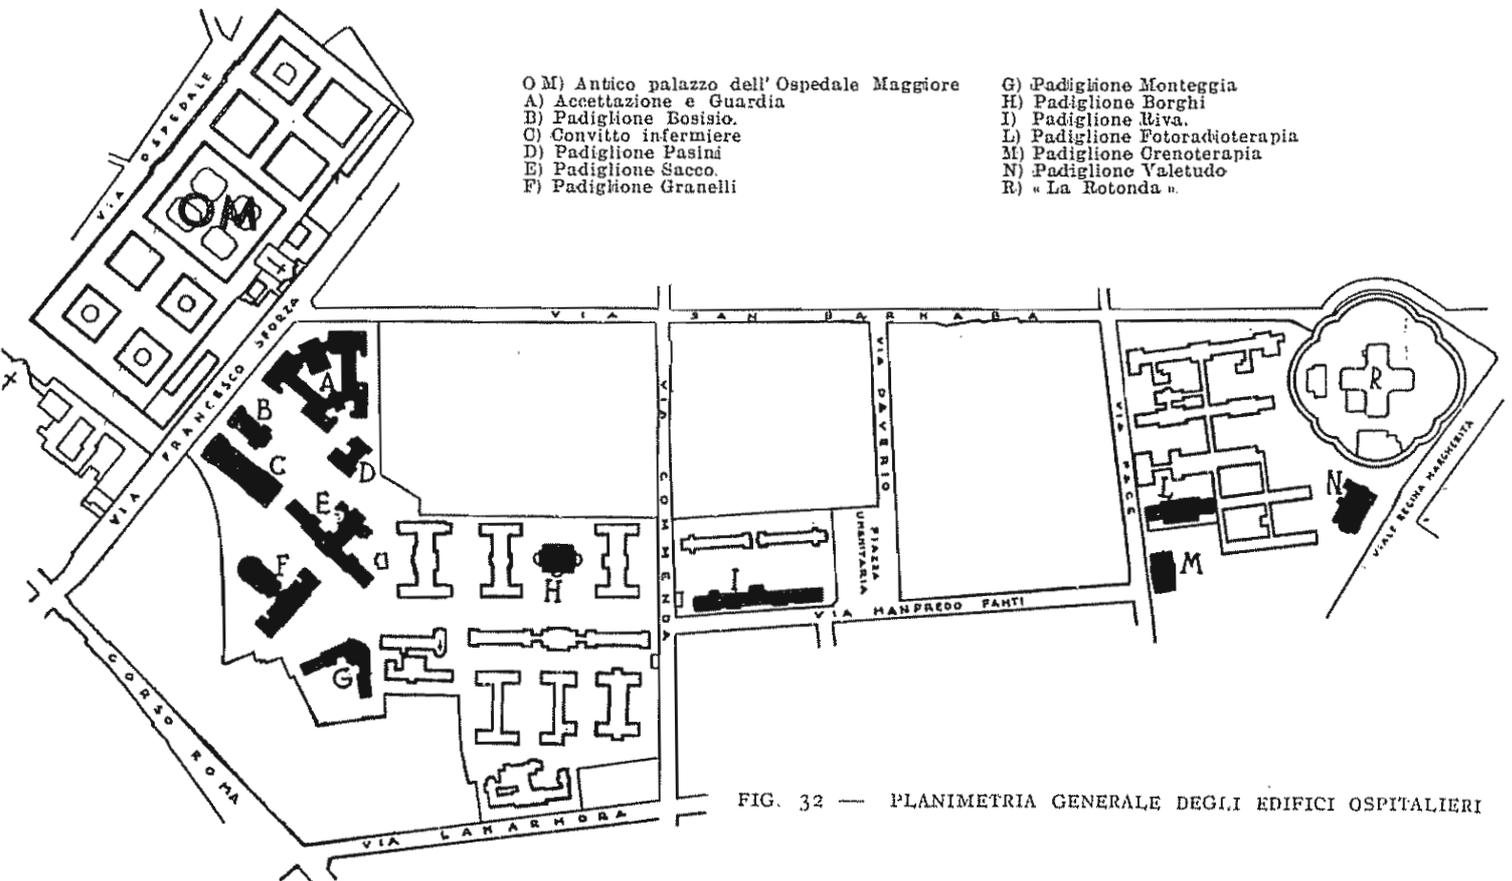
PLANIMETRIA GENERALE DEGLI EDIFICI OSPITALIERI
